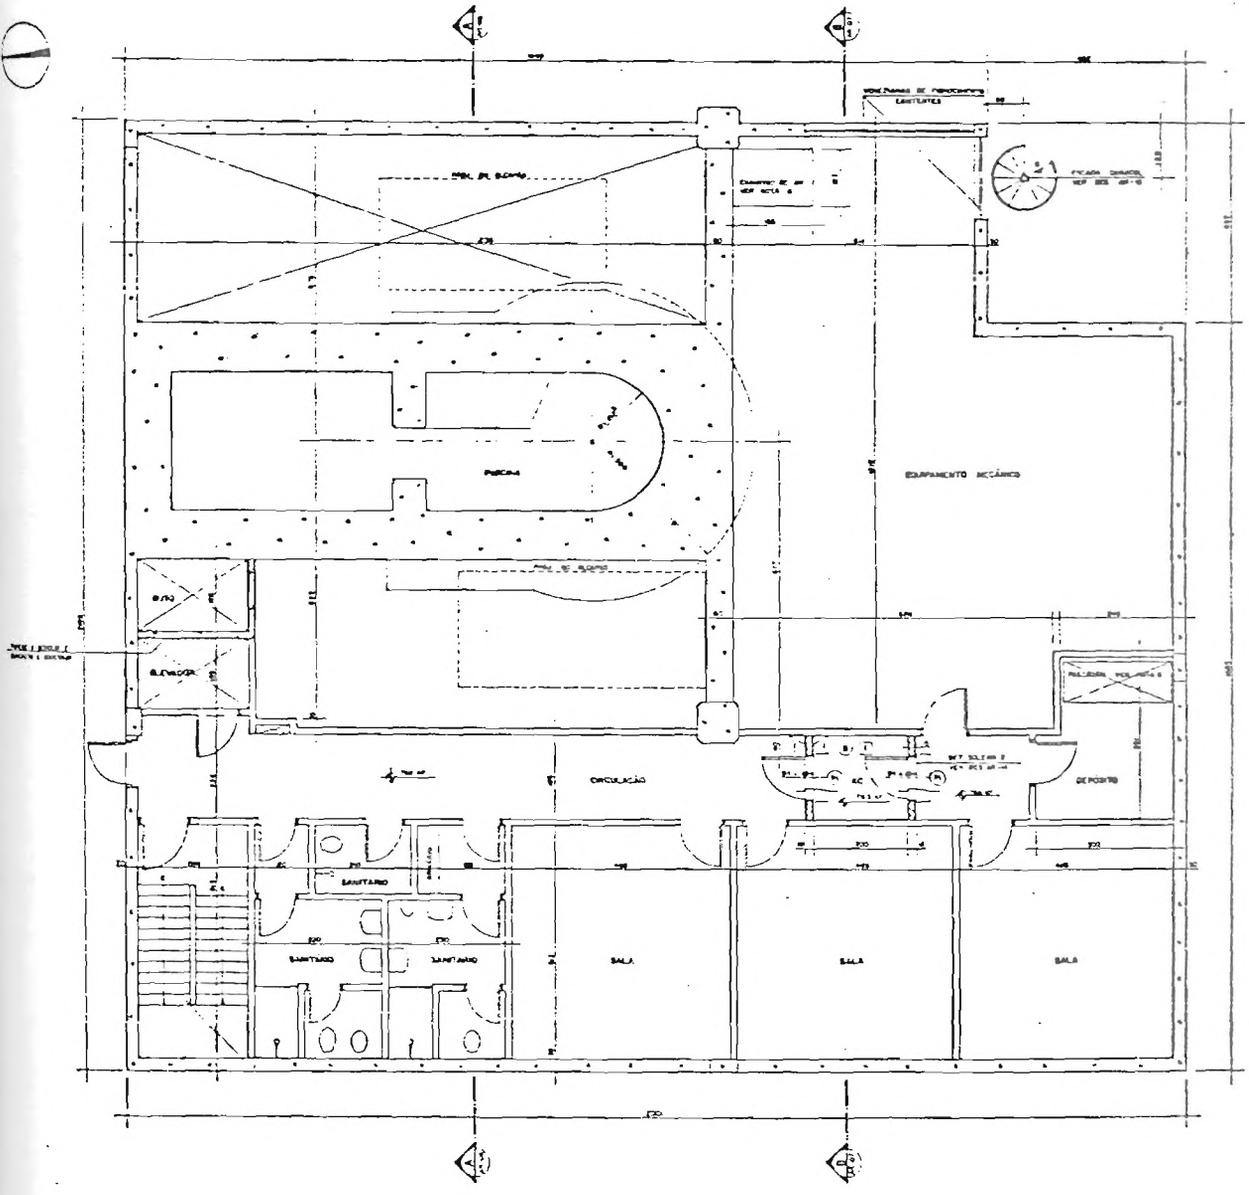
Planta do 29 pavimento mostrando as áreas quente e fria
